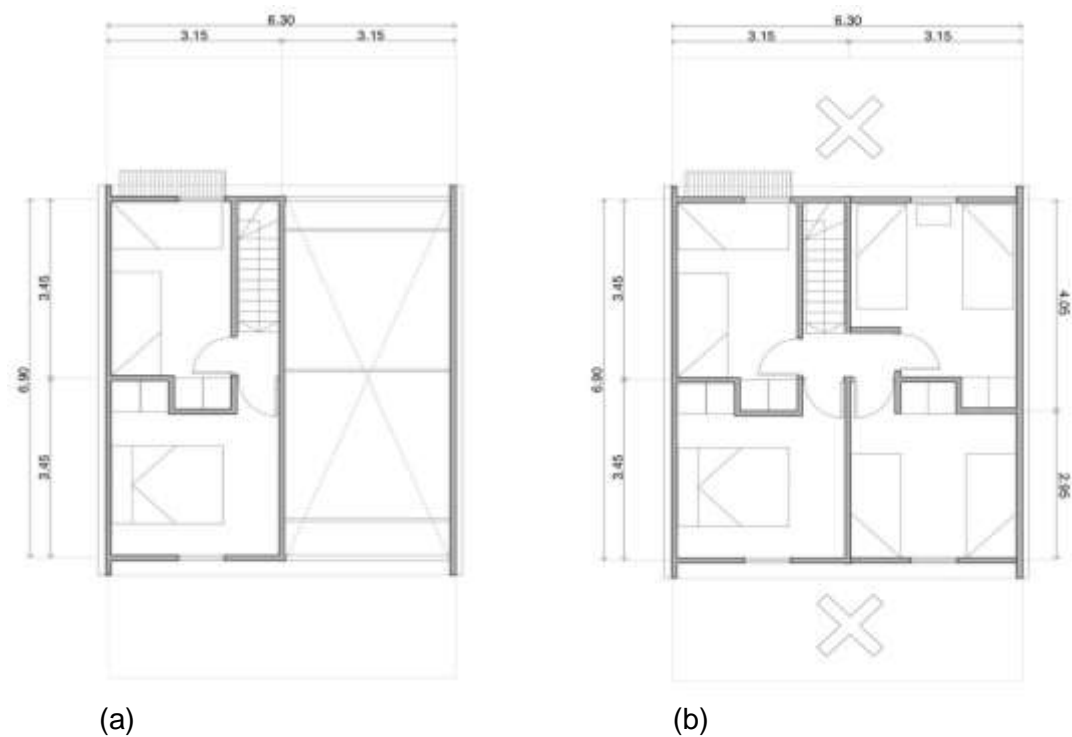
Projeto Arquitetônico para Villa Verde – Planta Baixa Pavimento Superior; (a) projeto construído; (b) previsão de ampliação.
